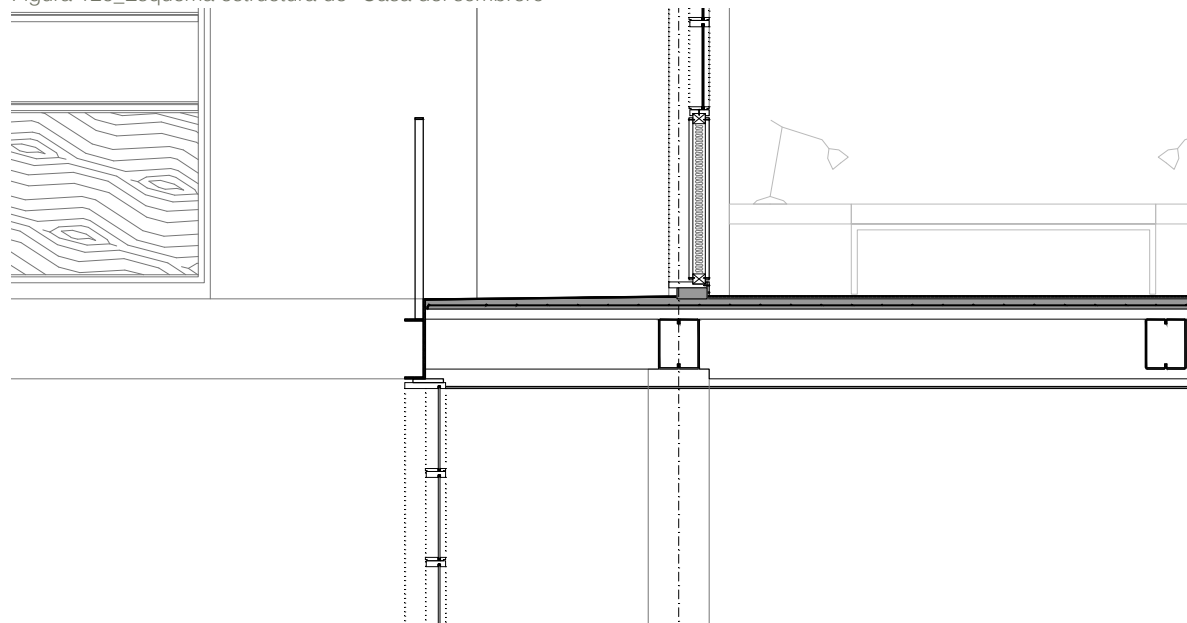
Imagen detalle constructivo "Casa del sombrero"
